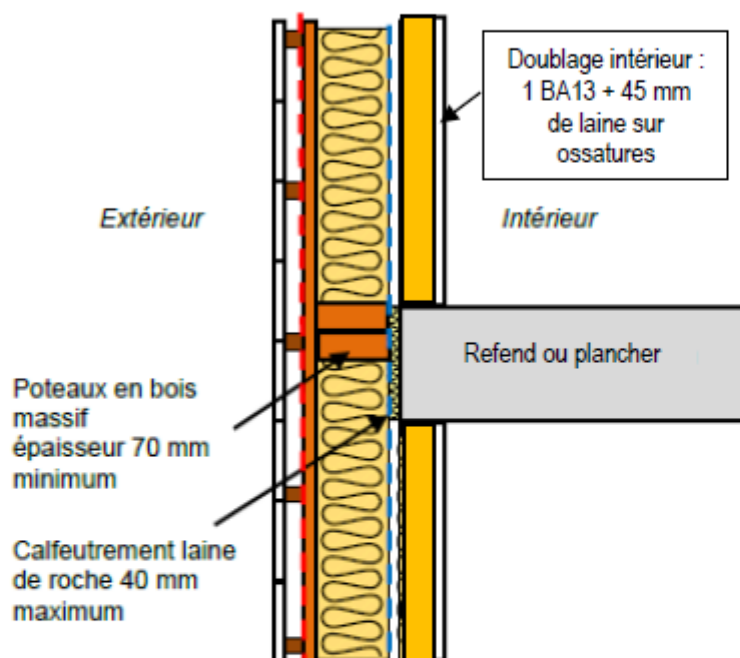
Liaison secondaire refend ou plancher – façades rideaux
